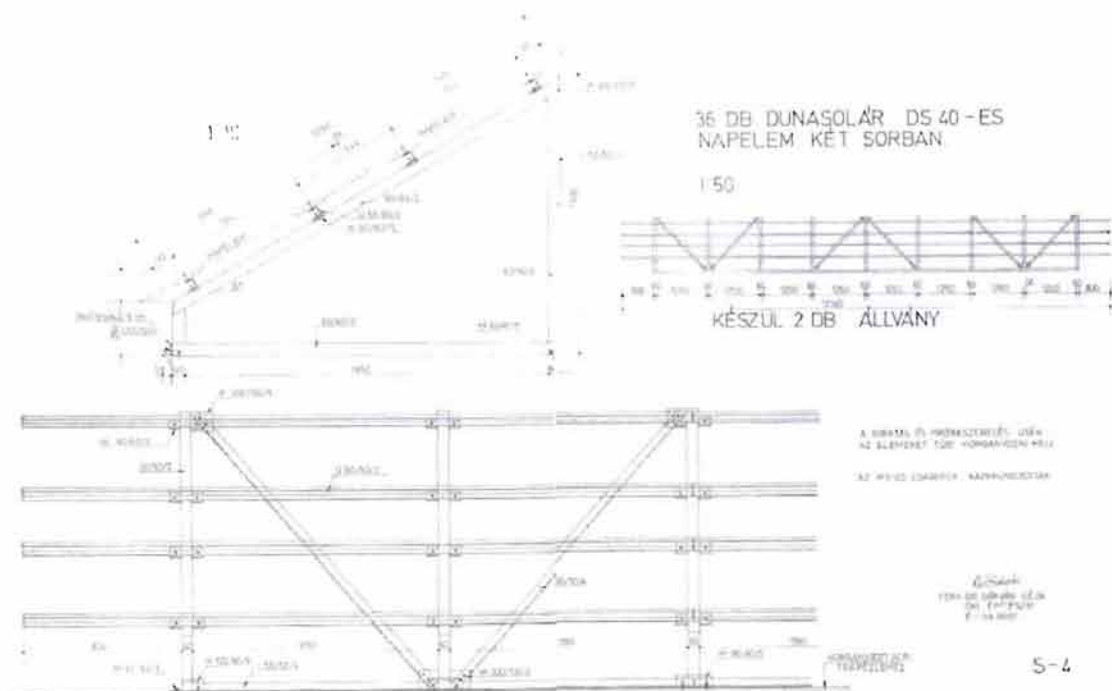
Schnittzeichnung des Gestells für die Solarmodule (Bildquelle: Universität Debrecen)
